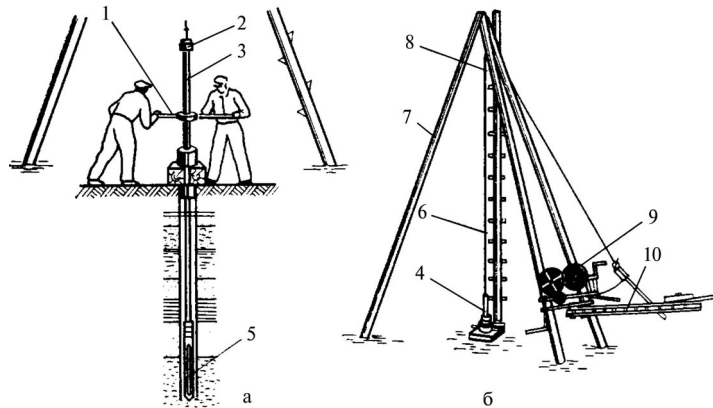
Бурова установка для улаштування неглибоких свердловин: а - буровий пристрій; б - підйомний пристрій; 1 - поворотний хомут; 2 - вертлюг; 3 - бурільна колона; 4 - обсадна труба; 5 - породоруйнуючий інструмент; 6 - канат; 7-тринога; 8 - блок; 9 - лебідка; 10 - балансир (важіль).
